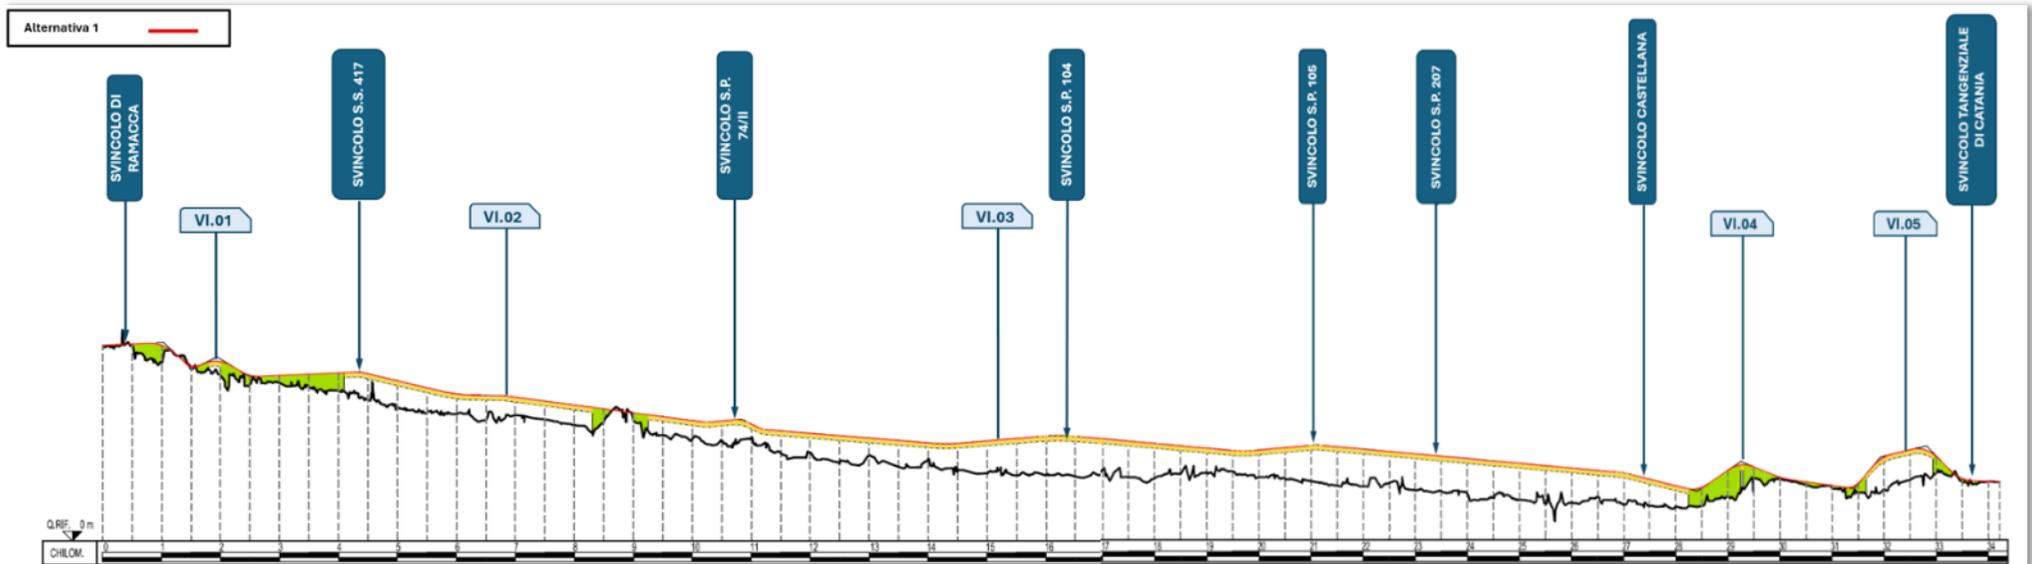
PROFILO LONGITUDINALE DI PROGETTO - ALTERNATIVA 1
